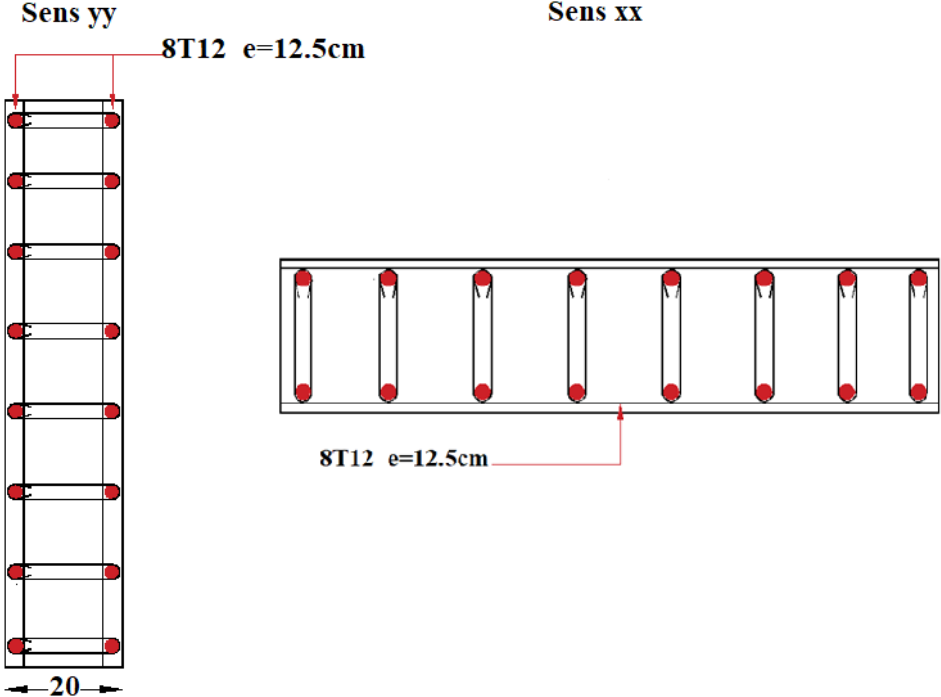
Dessin de ferrailage de voile périphérique.
